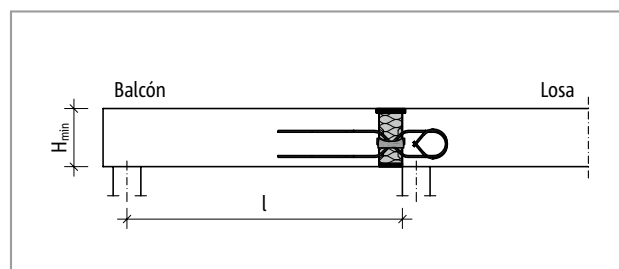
Schöck Isokorb® T tipo Q-VV: Sistema estático (T tipo Q-VV1 hasta Q-VV5)
